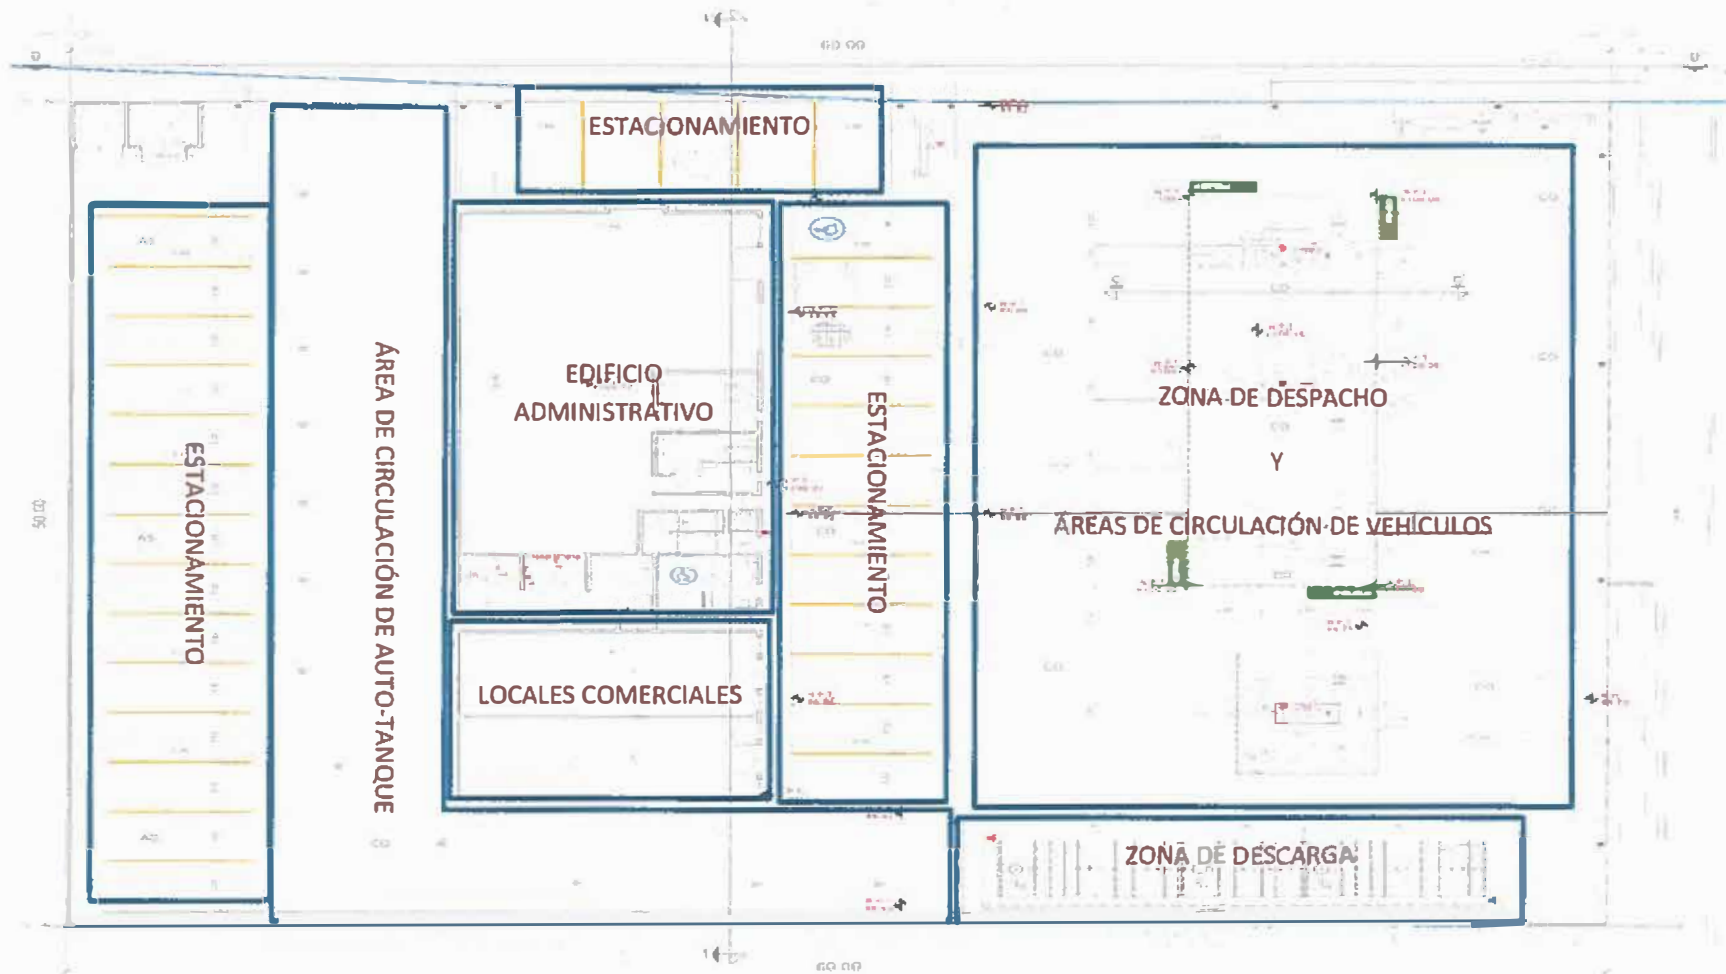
Plano de conjunto de la Estación de Servicio.
